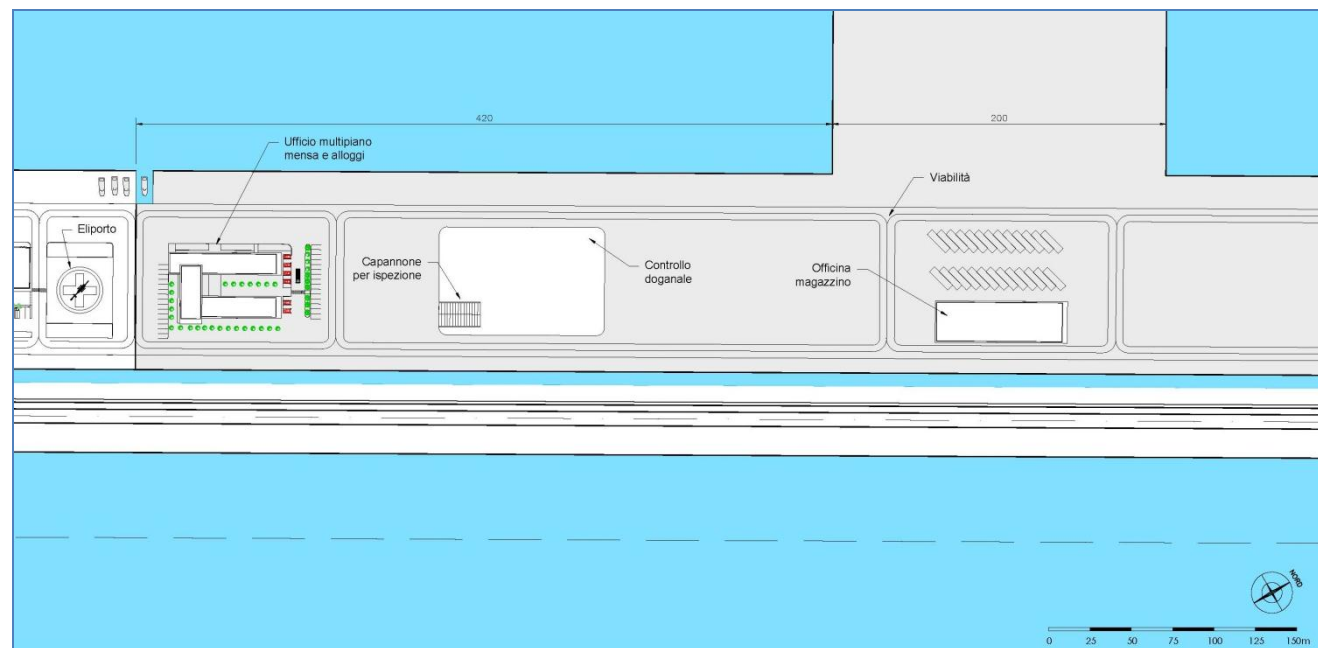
Banchina Servizi : estratto planimetrico con logistica afferente al Terminal containers
